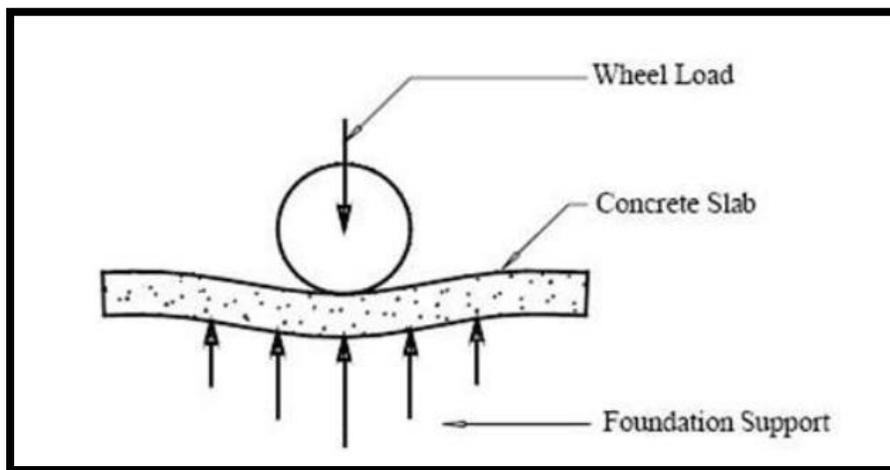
Transferencia de carga de una rueda en una estructura de pavimento rígido
